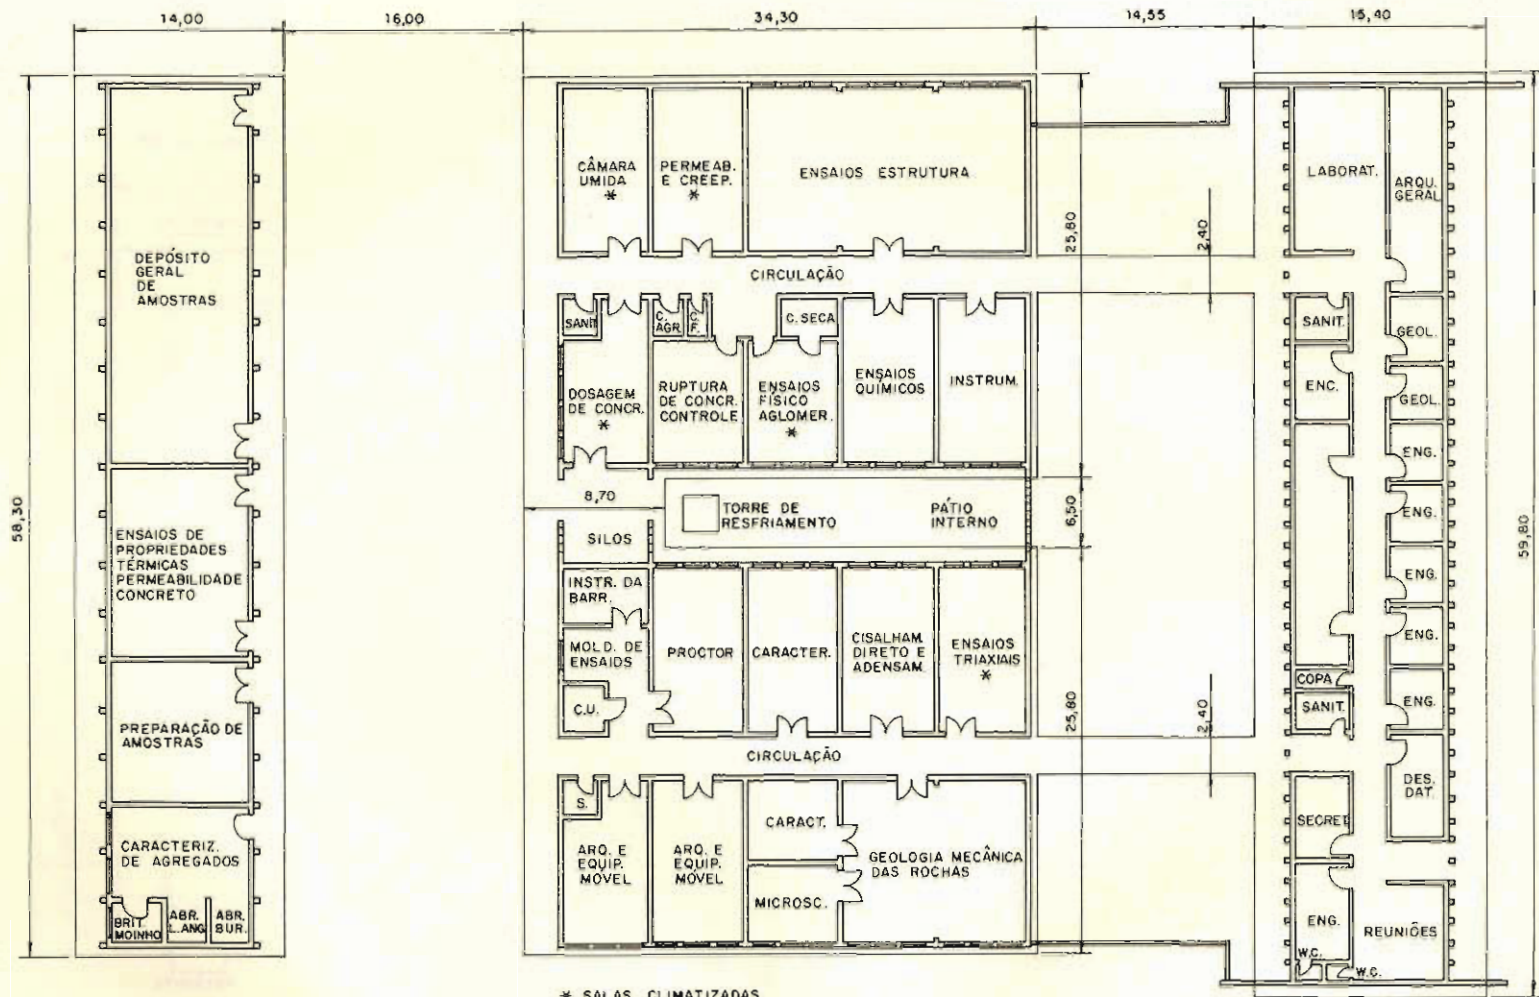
Planta do Laboratório de Ilha Solteira
